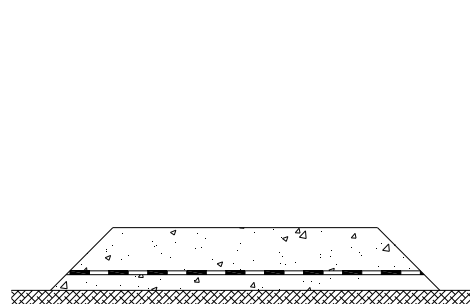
Dammbau auf wenig tragfähigem Untergrund
